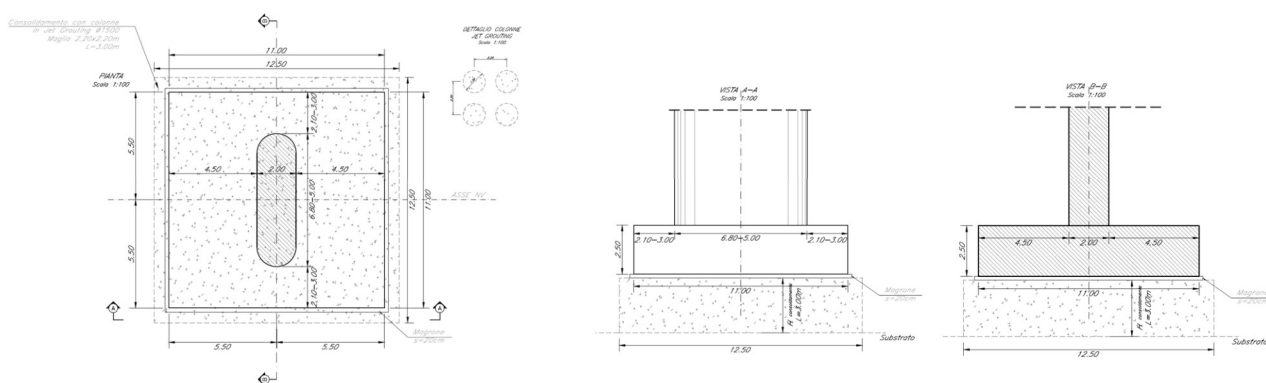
Pianta e sezioni fondazione diretta su colonne in jet grouting D1500 interasse $i=2.20$ m
